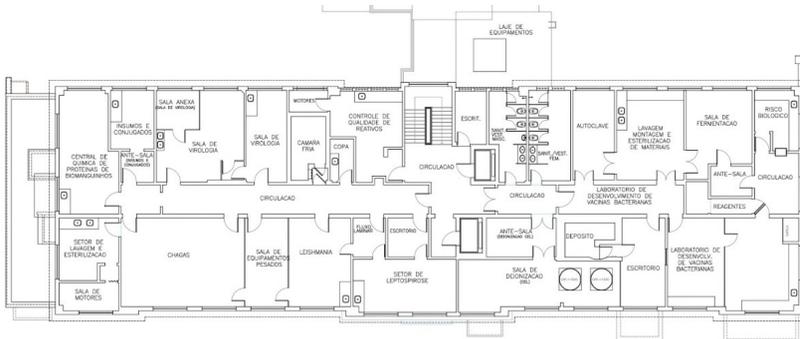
Planta baixa 3º pavimento - Pavilhão Rockefeller.
